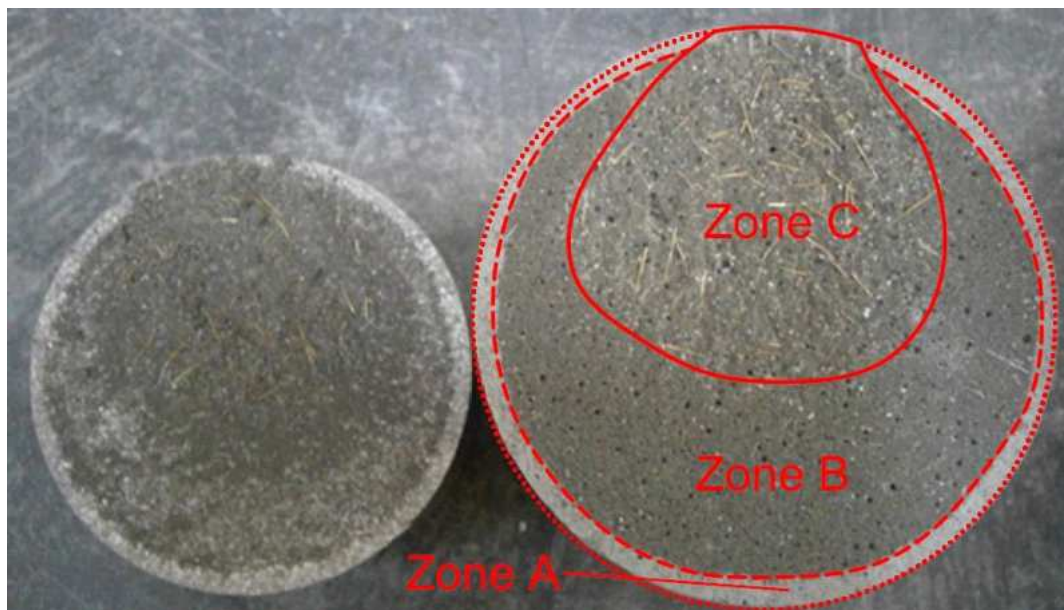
Bruchfläche UHPC mit Stahlfasern
